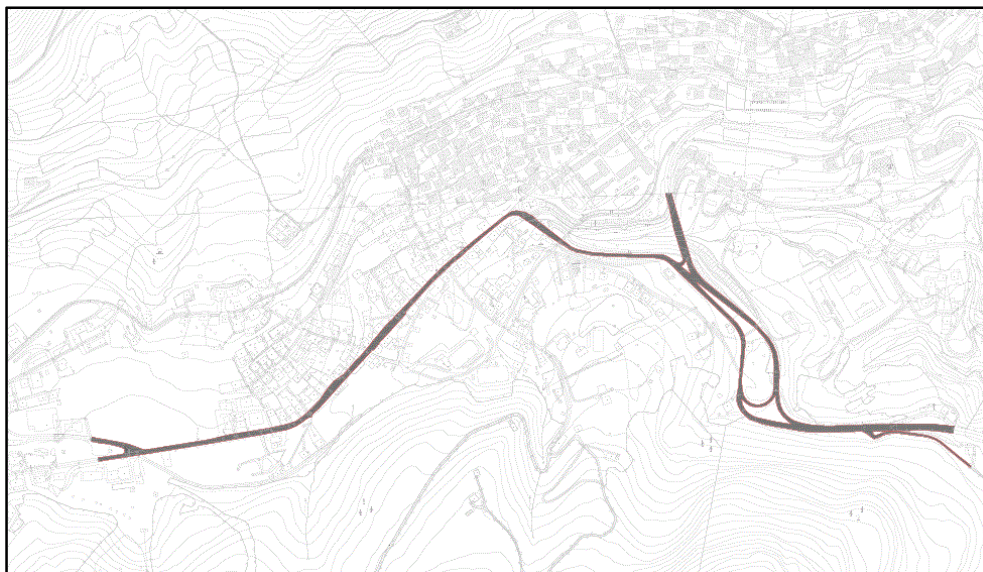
Planimetria dell'attuale tracciato del tratto della SS51 attraversante Tai di Cadore (Alternativa 0)
